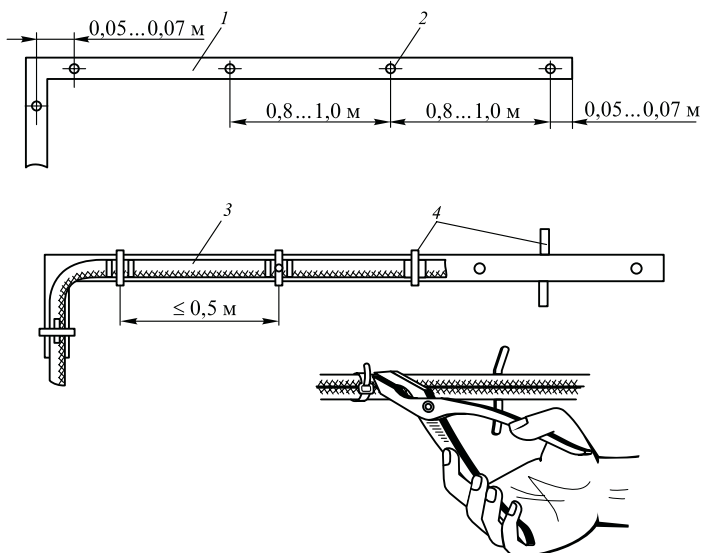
Крепление кабелей на стальных полосах и лентах:
